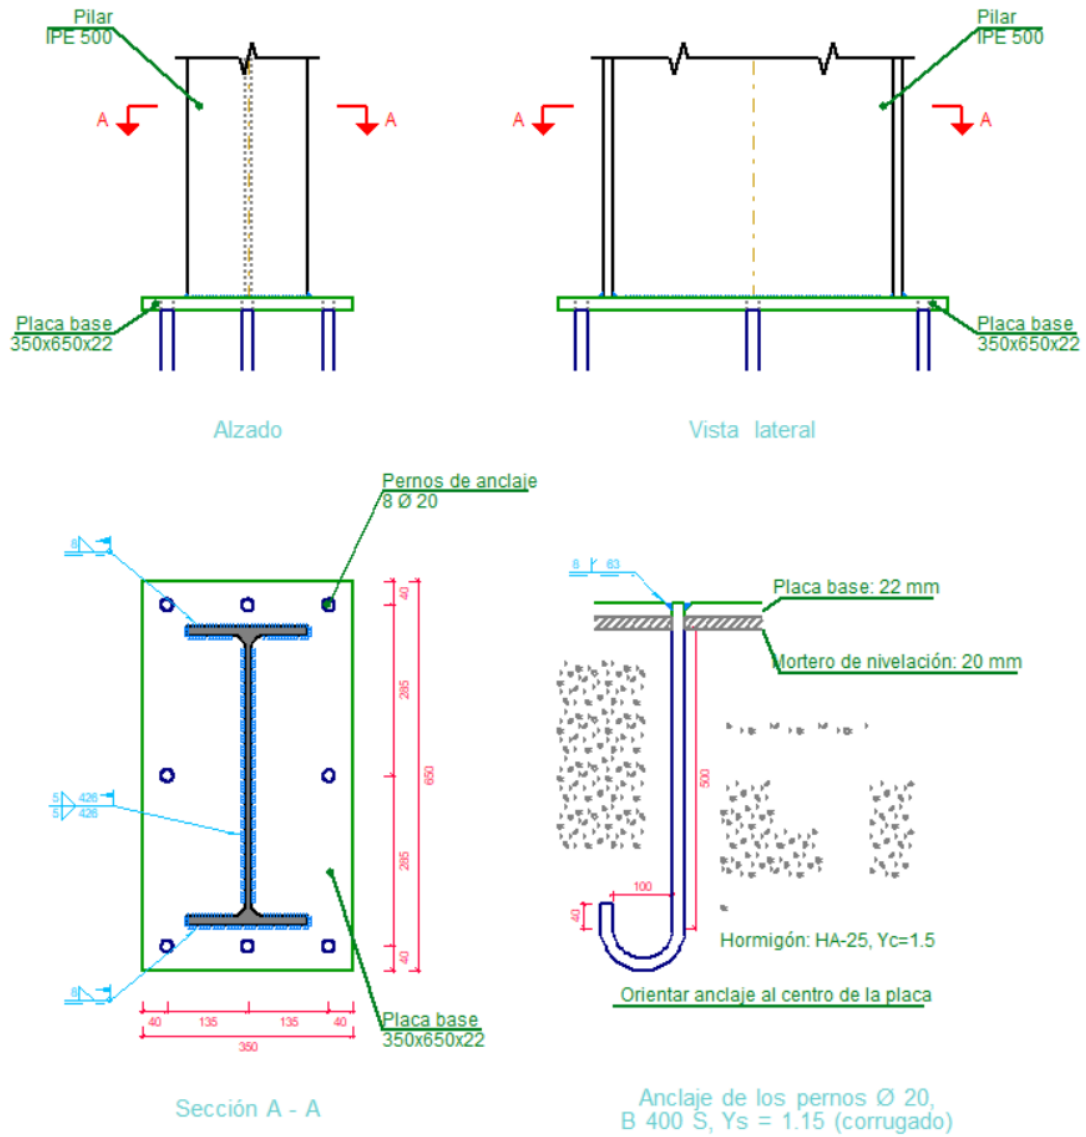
Despiece de la placa de anclaje diseñada para el pilar IPE 500
